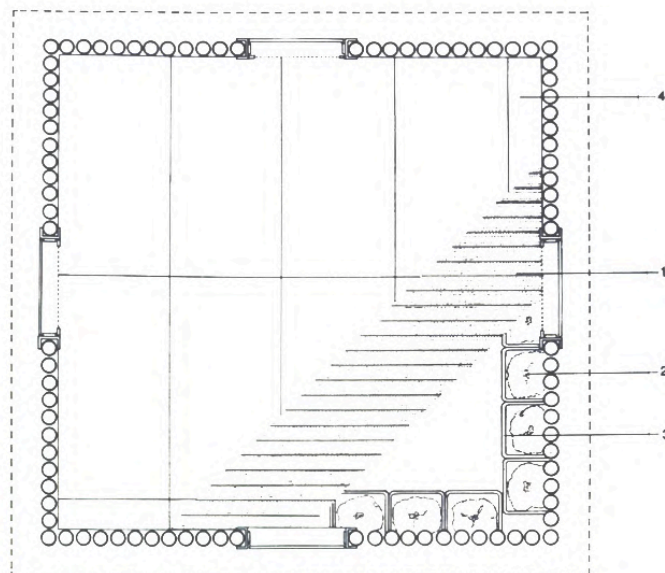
Planta del proyecto original. Fuente: (B) p. 47
